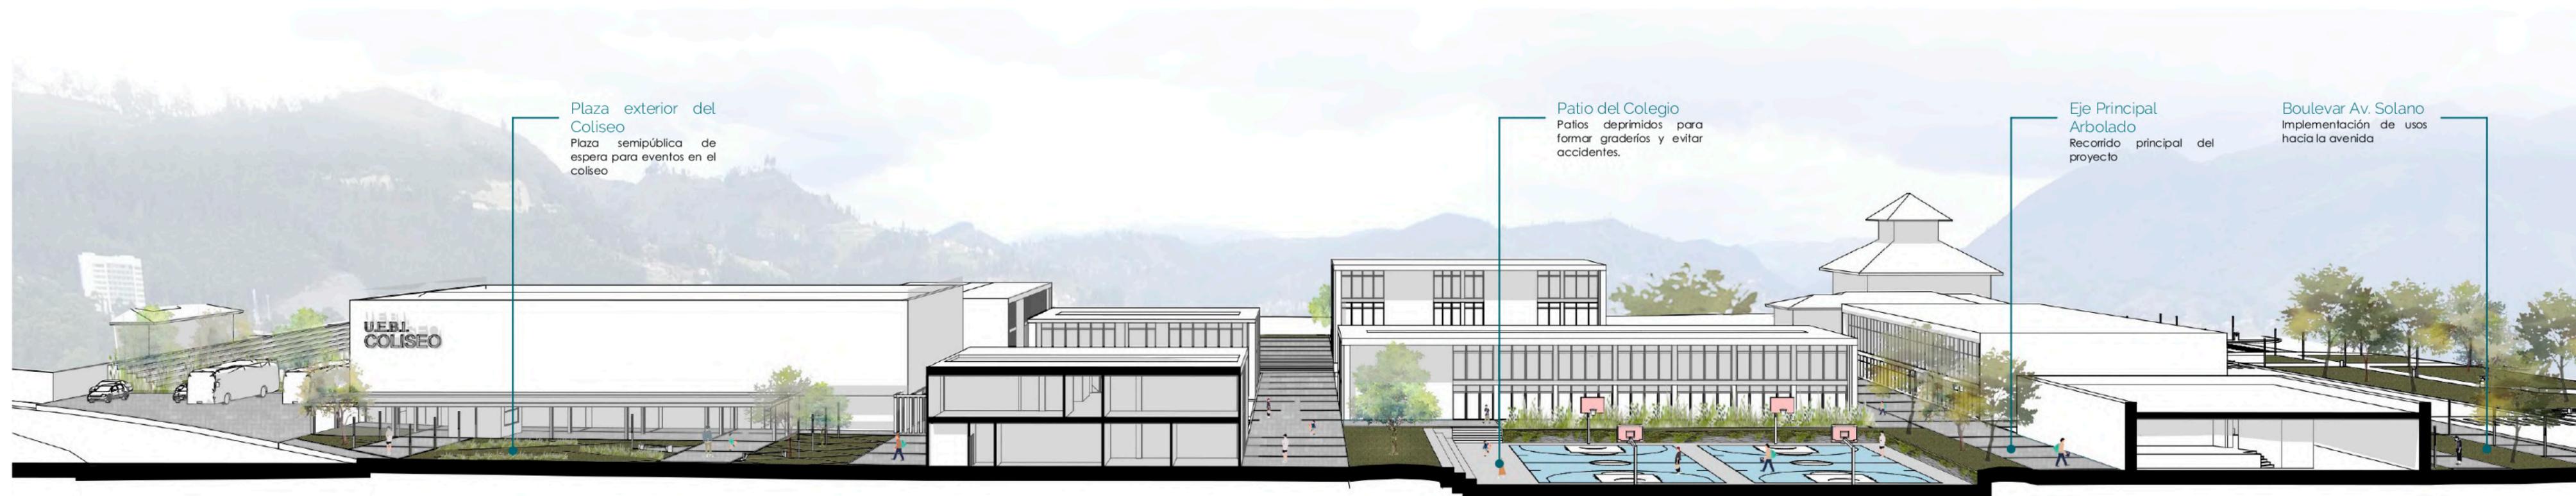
| Sección general de plazas | Fuente: Elaboración Propia
